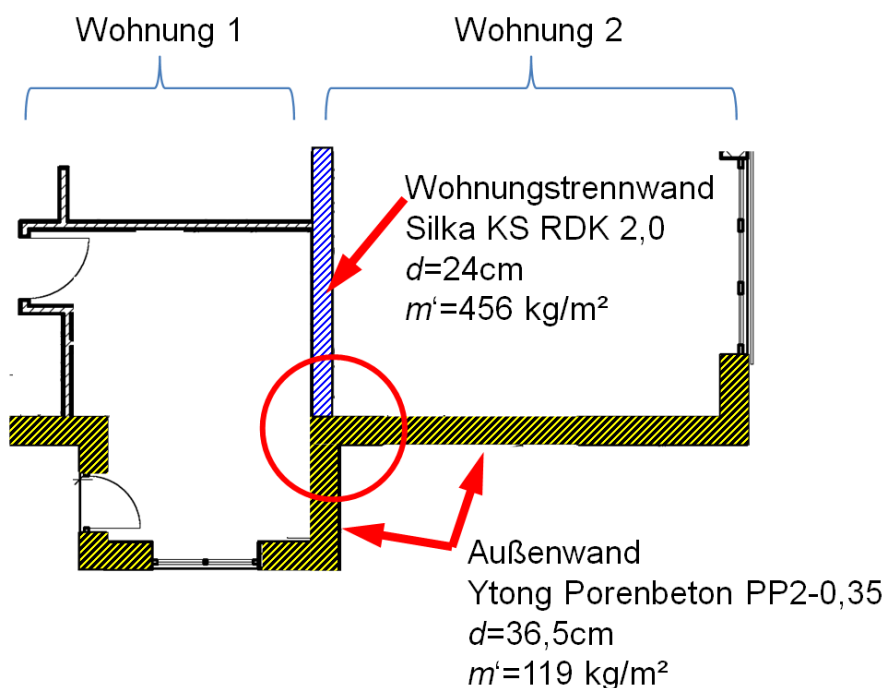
Skizze – Beispiel horizontal versetzte Grundrisse
